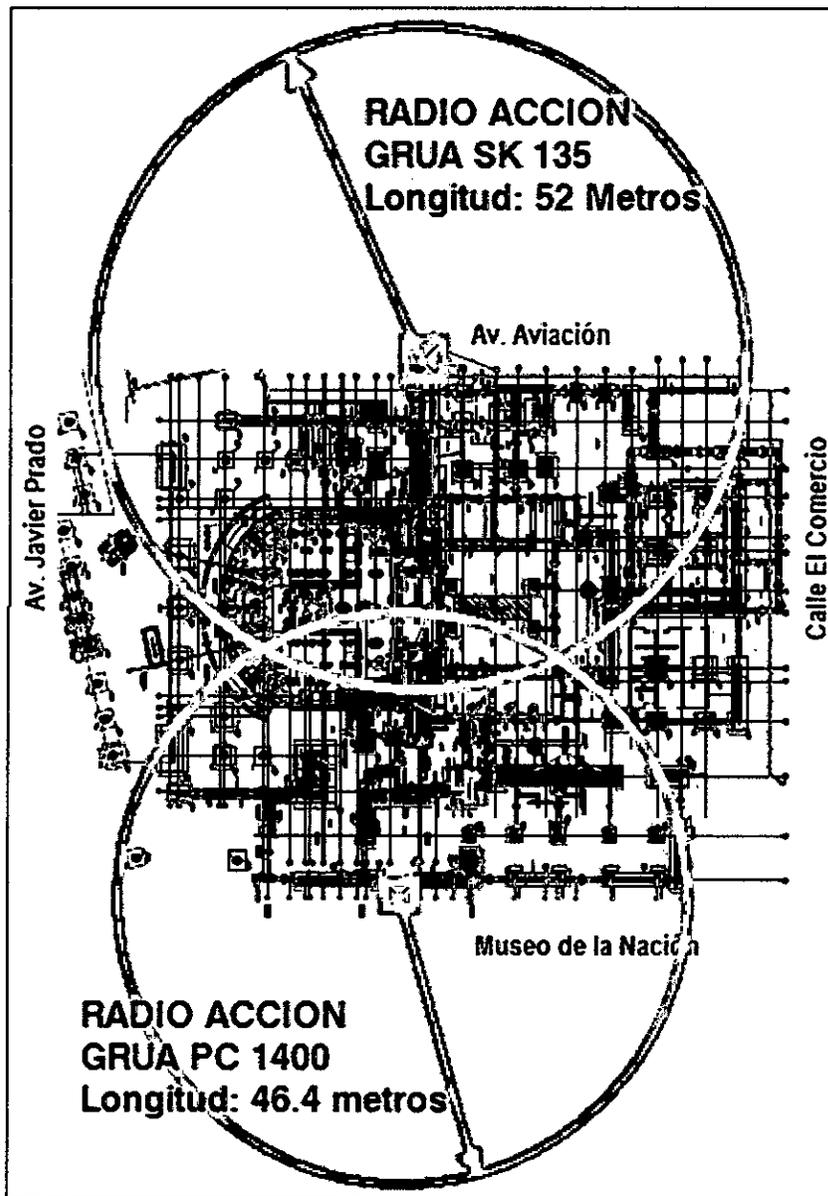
POSICIÓN FINAL DE LAS GRUAS TORRES.
